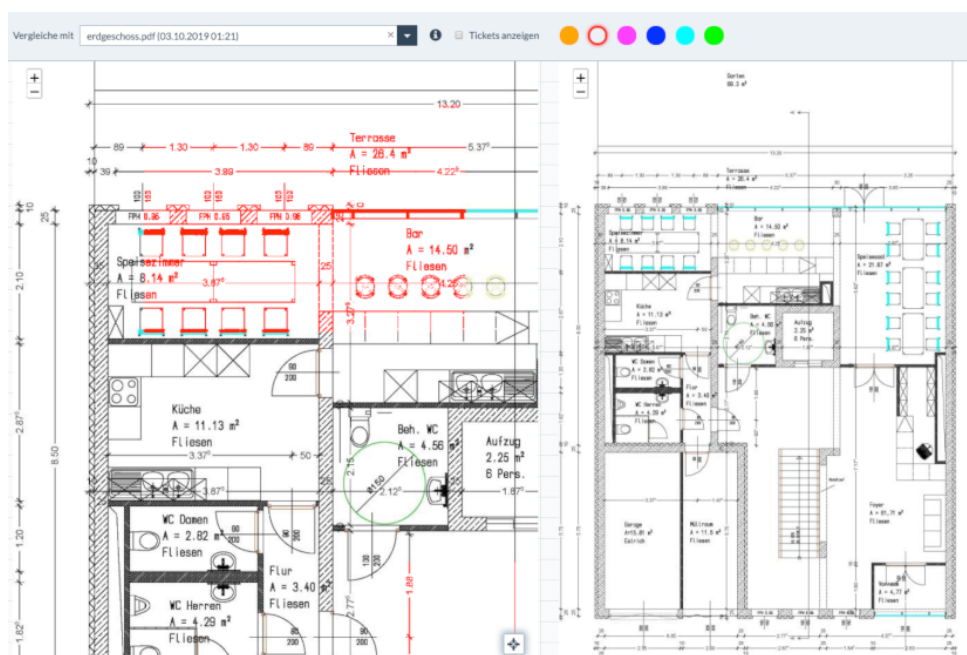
Farbliche Hervorhebung von Änderungen eines Grundrisses in Planradar [36]
